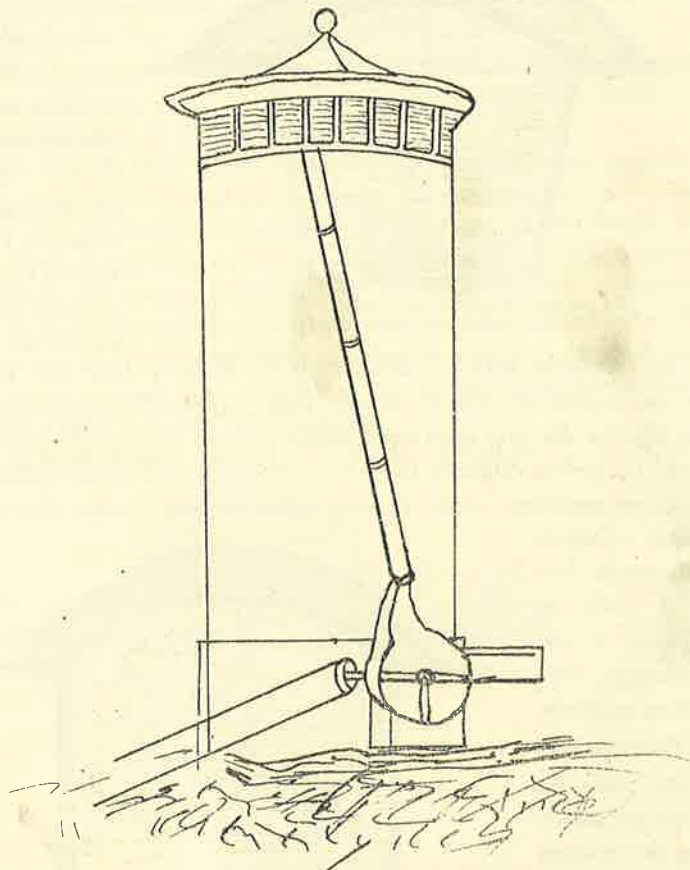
Silo elevado tipo americano de concreto para 100 toneladas de forragem.
